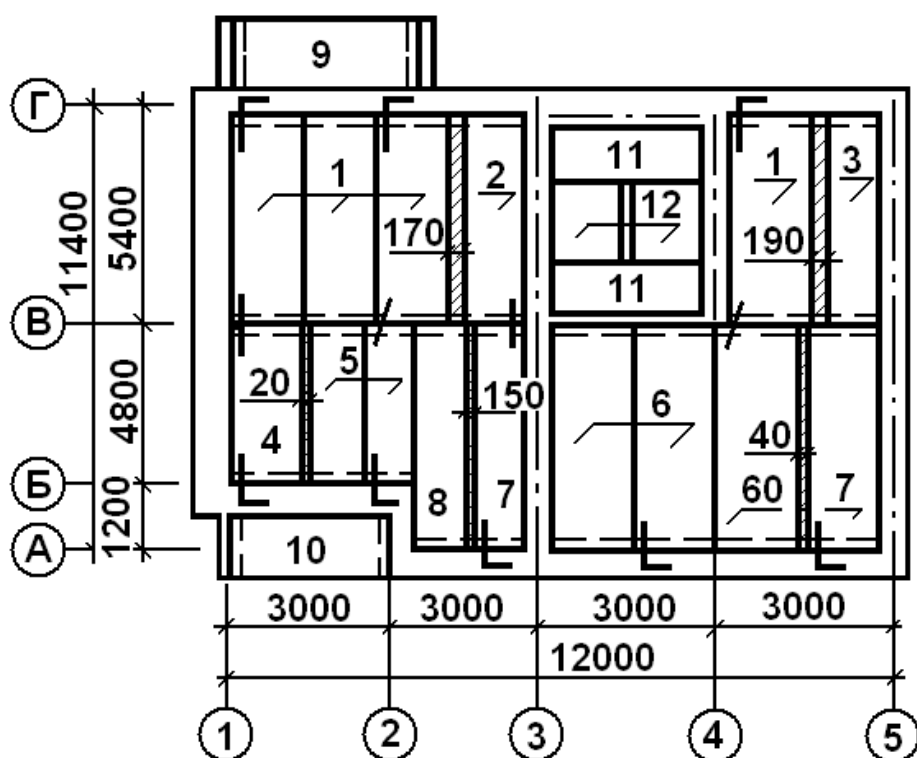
Пример плана перекрытия для здания с продольными несущими стенами
